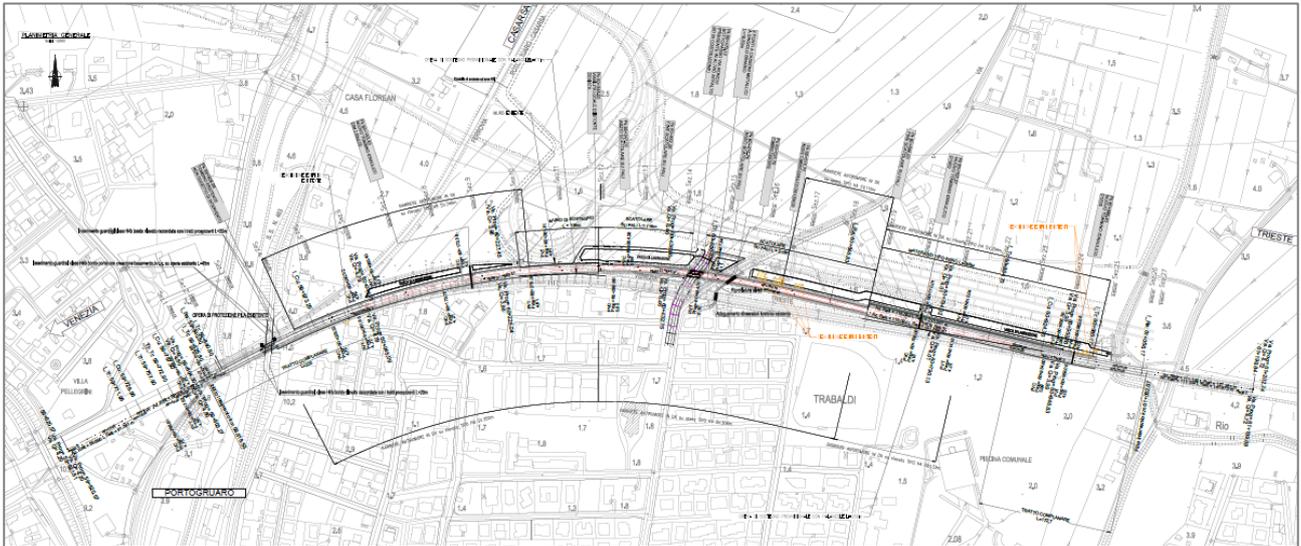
Variante di Portogruaro: Planimetria di progetto – Sviluppo generale
